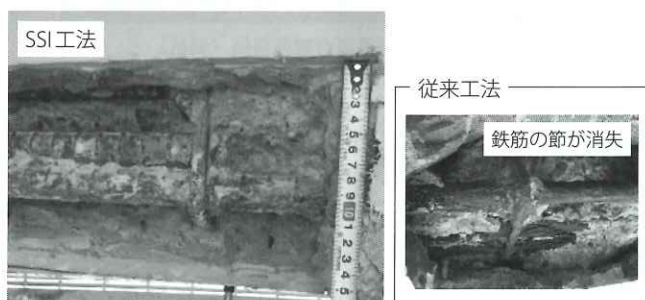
断面修復補修20年経過後の鉄筋腐食状況
